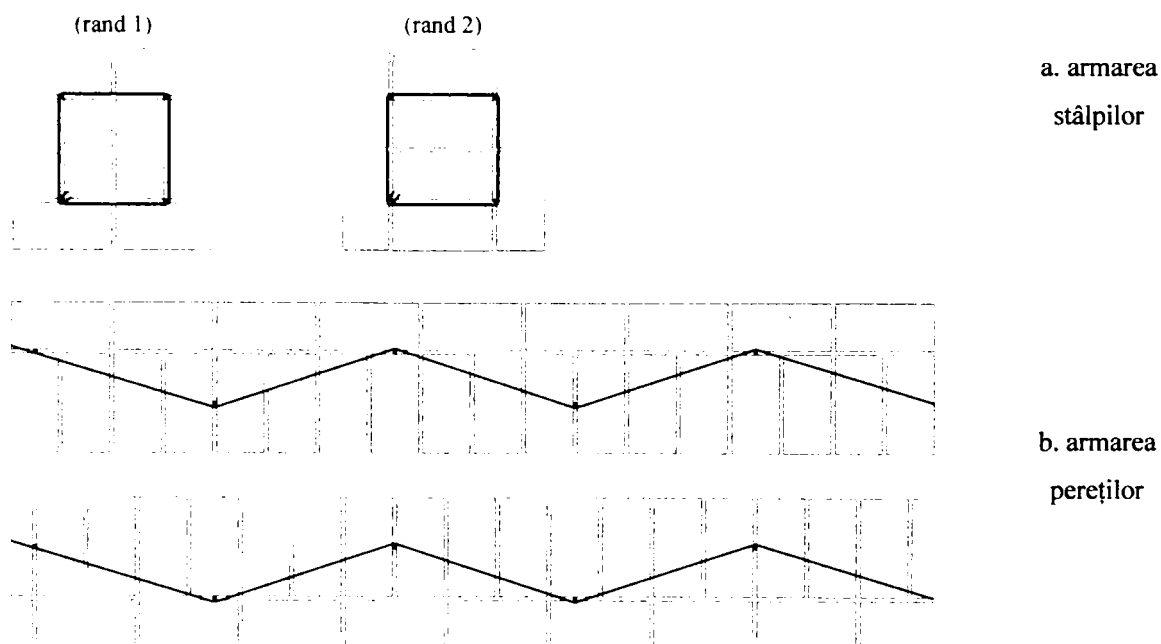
Armarea longitudinală interioară a zidăriei
